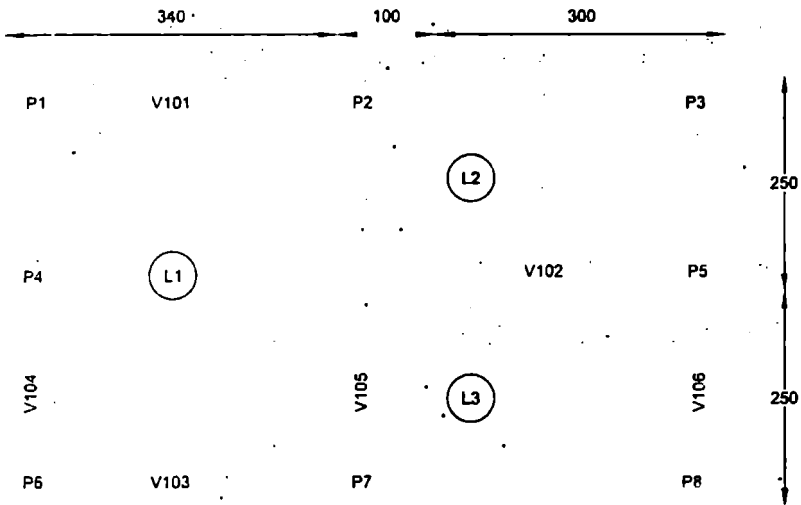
Planta de formas do pavimento do exemplo 4.
